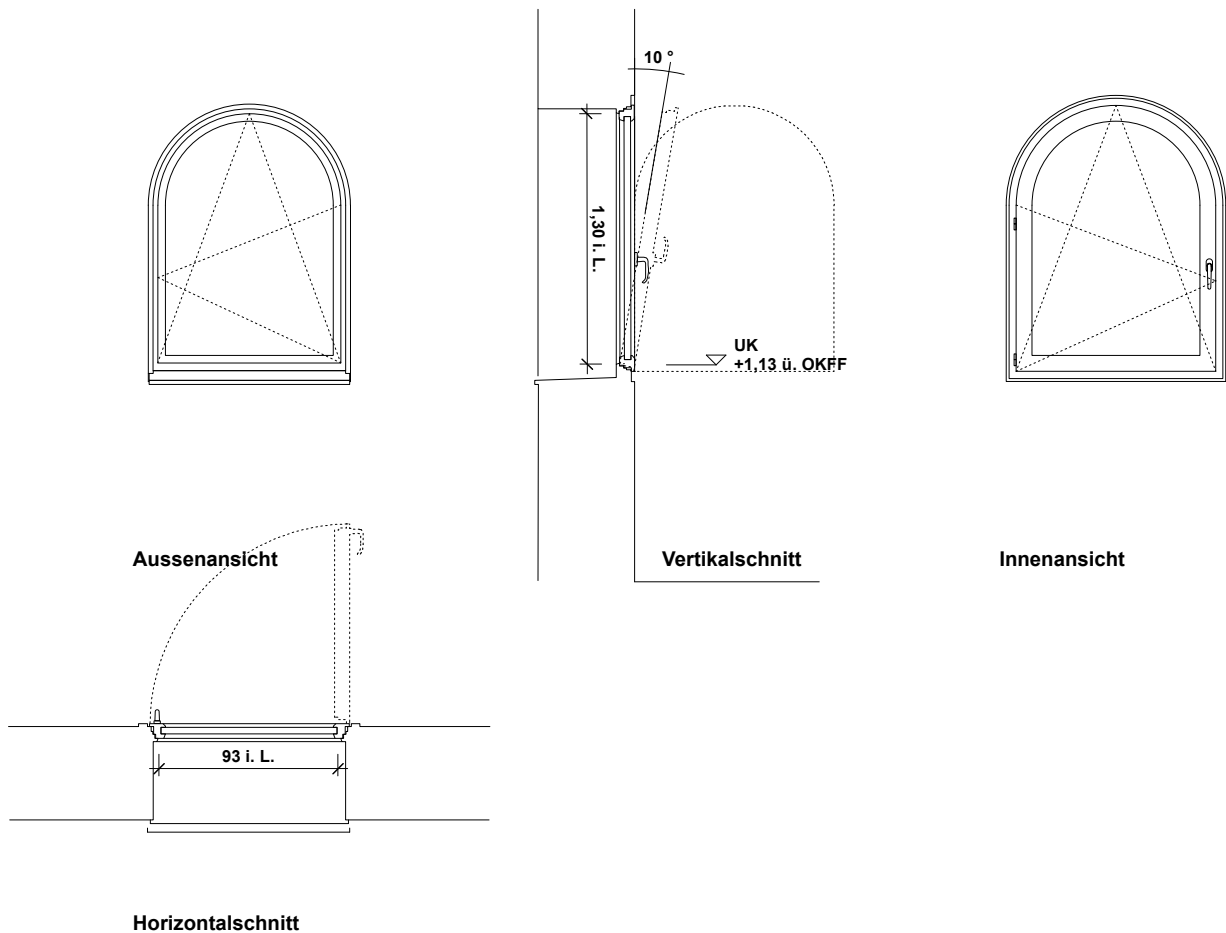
, Detailzeichnung der Fenster, ohne Maßstab, „Mittelgroß“, Gebäude Leichtbeton, Quelle: Tilmann Jarmer, TU München
